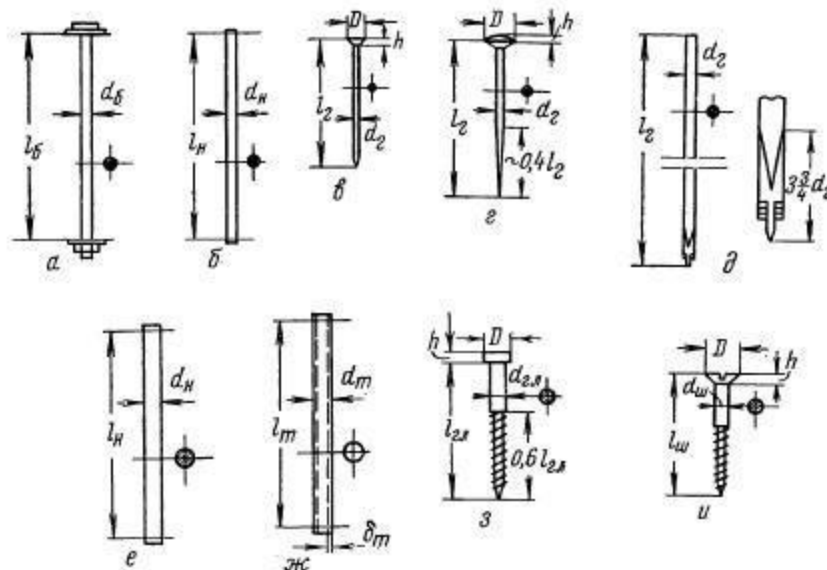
Цилиндрические нагели: а) болт; б) штырь; в) гвоздь проволочный; г) гвоздь кованный; д) гвоздь крупноразмерный со специальной заточкой конца; е) дубовый нагель; ж) трубка; з) глухарь; и) шуруп.
